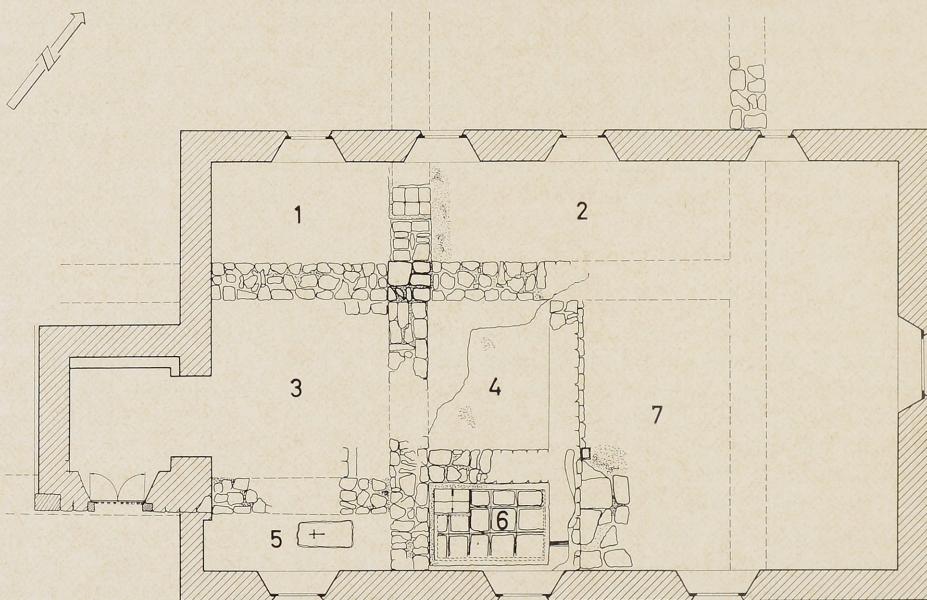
Leisel. Grundriß der Kirche mit römischen Bauresten
